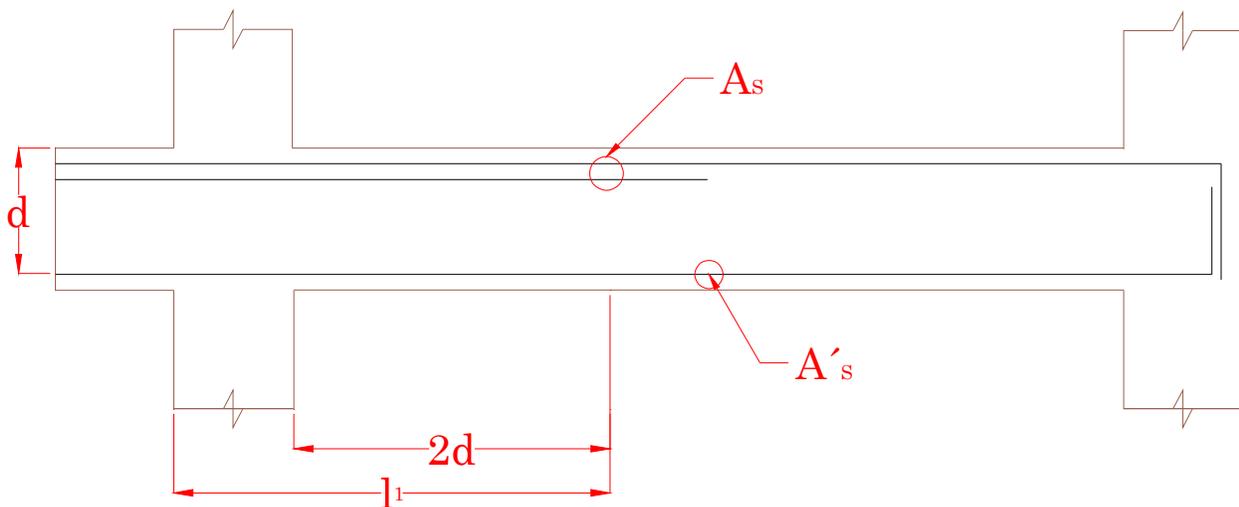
Requisitos para el Refuerzo Longitudinal de Vigas de Marcos de Concreto
